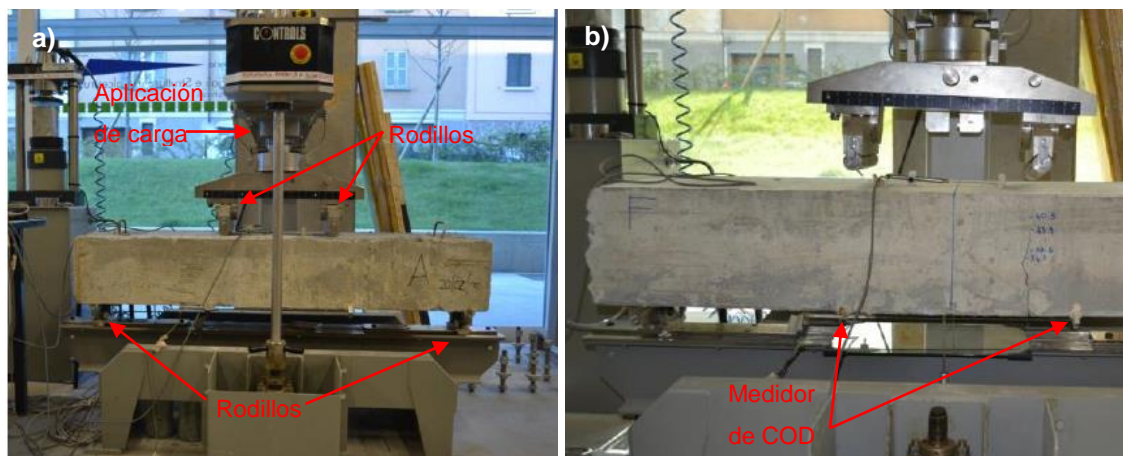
Ensayo a escala real 4pb de Viga A y Viga F.
